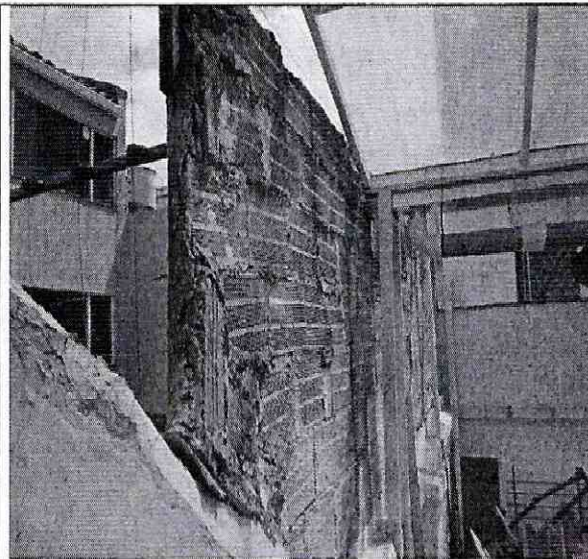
Muro en mampostería simple sin reforzar ni confinar.
